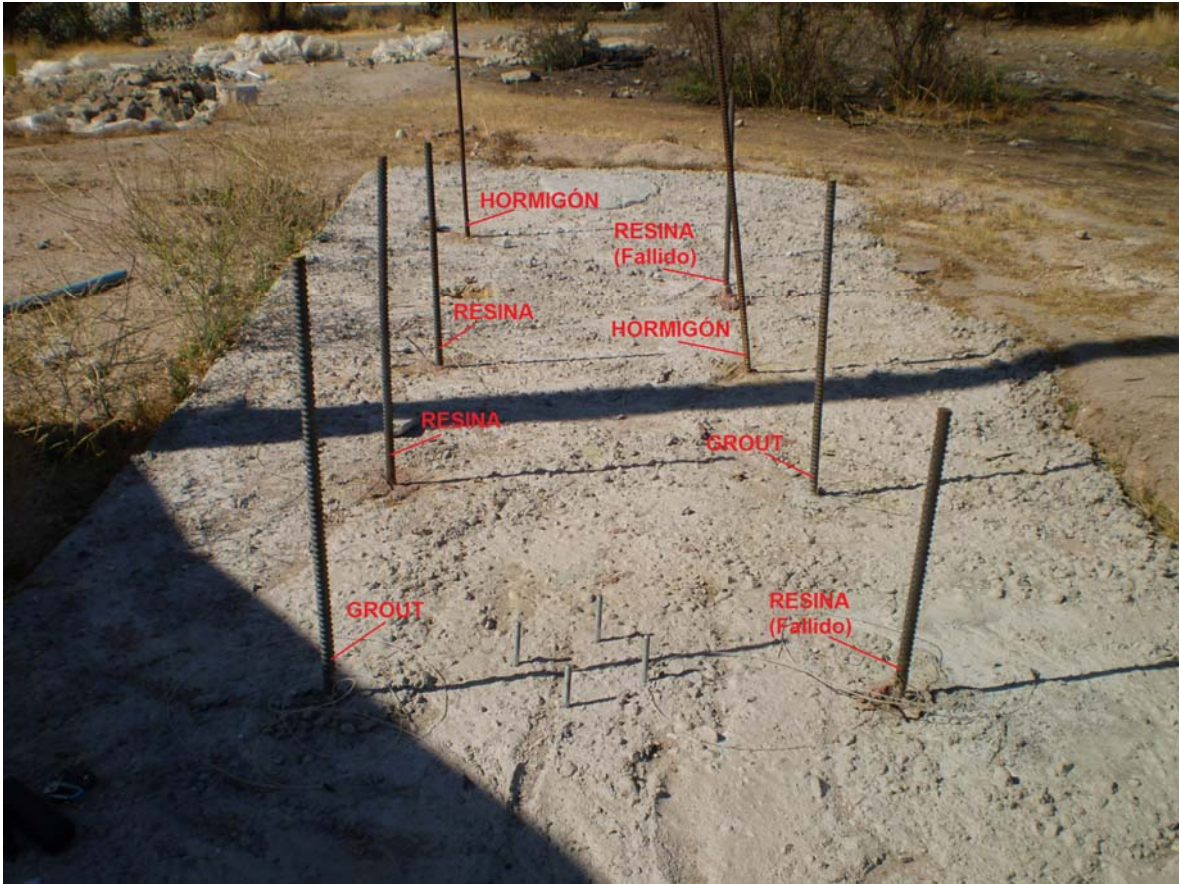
Vista en perspectiva de losa de hormigón y distribución de los ensayos tipo zona anclada realizados (modelo A de ensayos)
